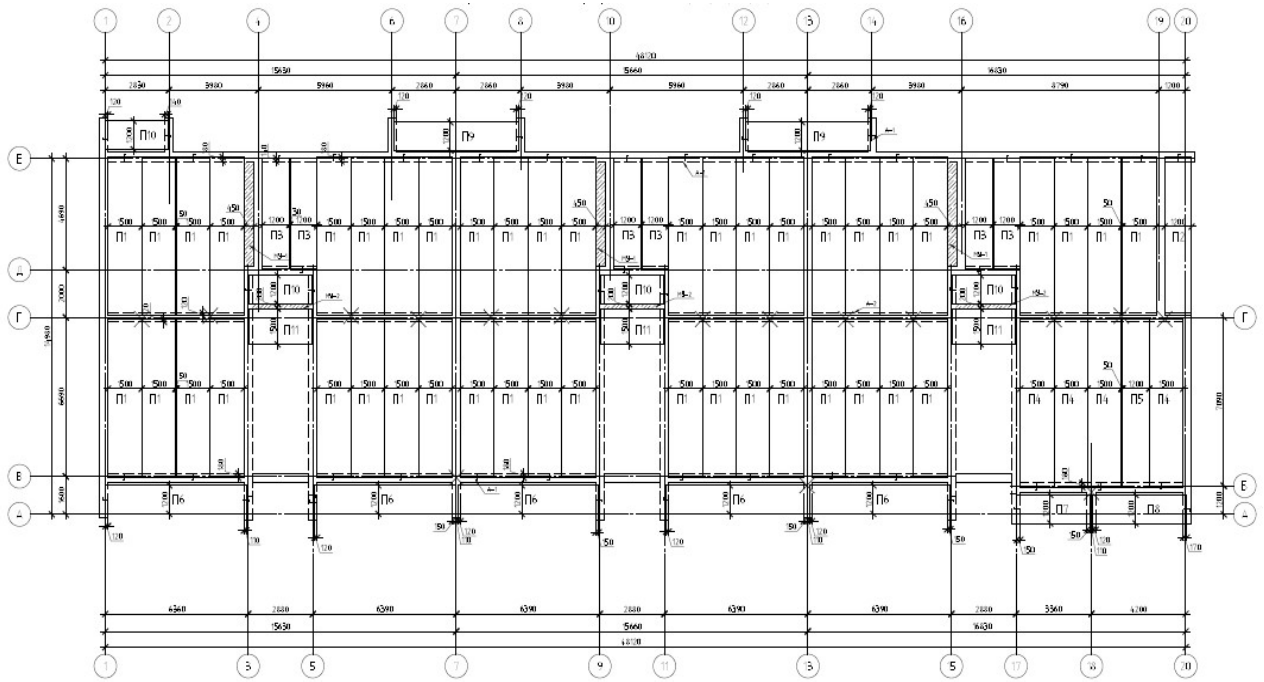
схема расположения плит перекрытия типового этажа
